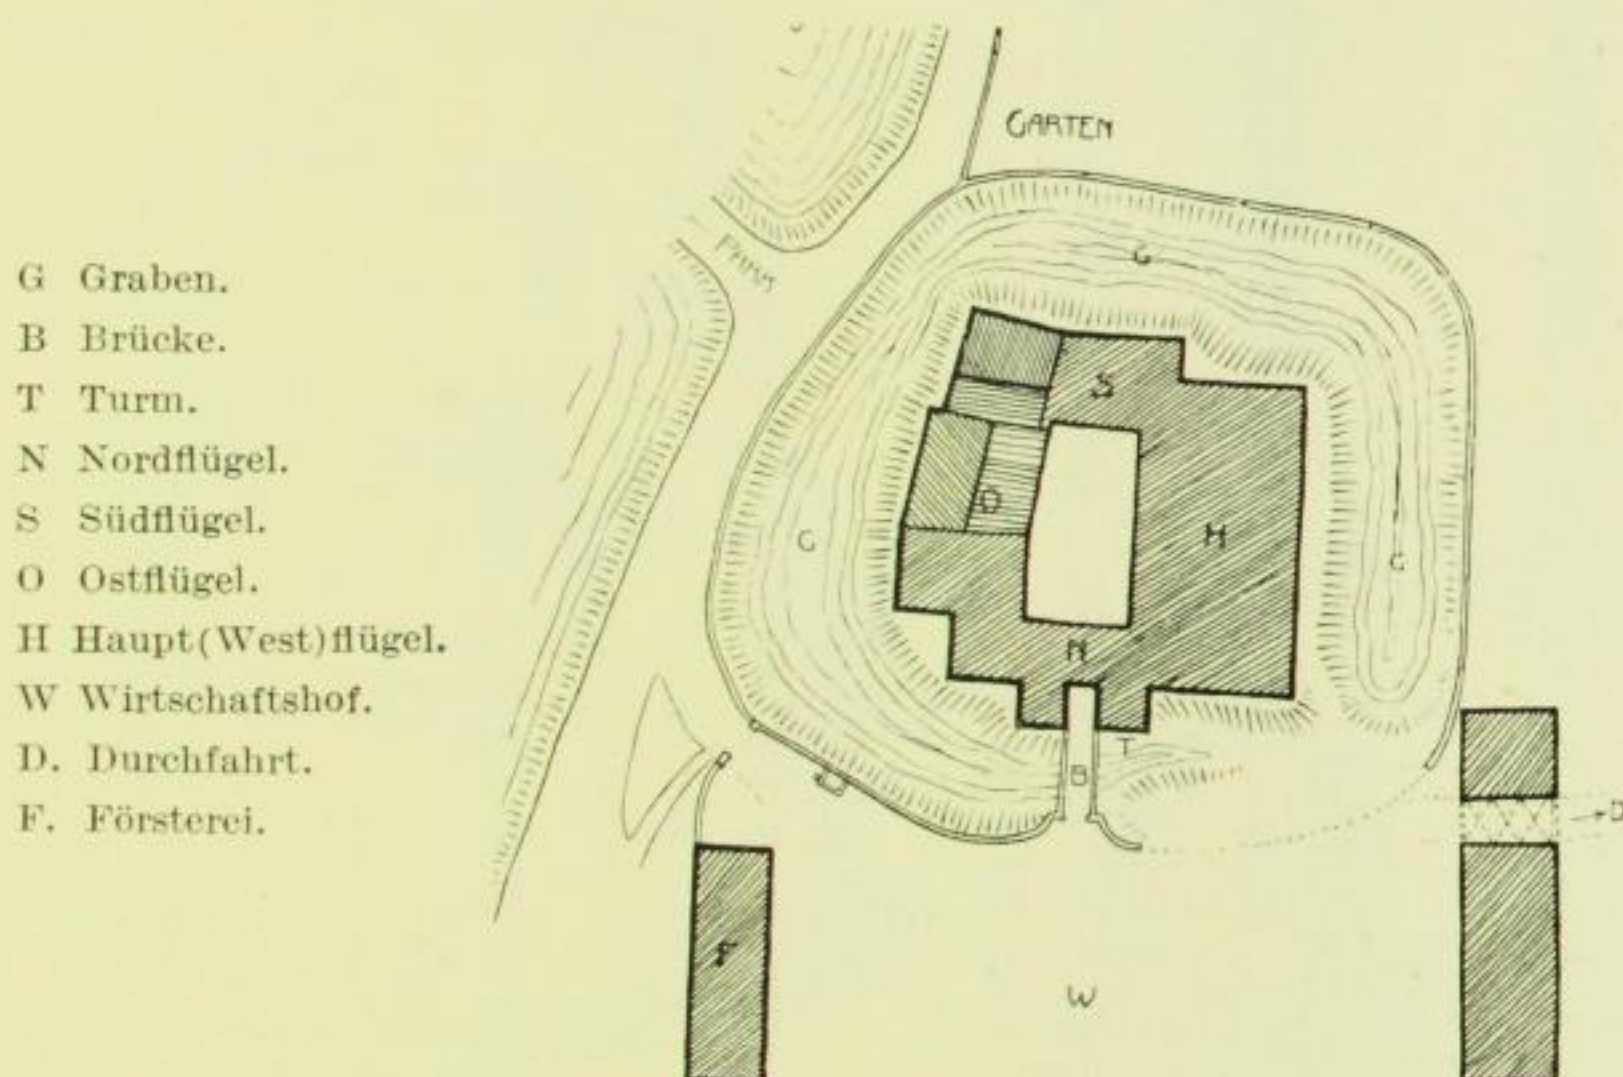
Großhennersdorf, Schloß, Lageplan.
